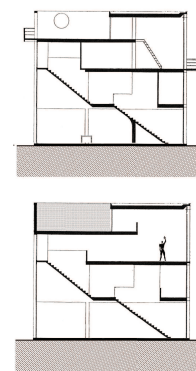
Au dessus, la coupe d'origine sur l'escalier. En bas, le dispositif ouvert de la structure des planchers met en relation tous les niveaux à travers la faille de l'escalier.
